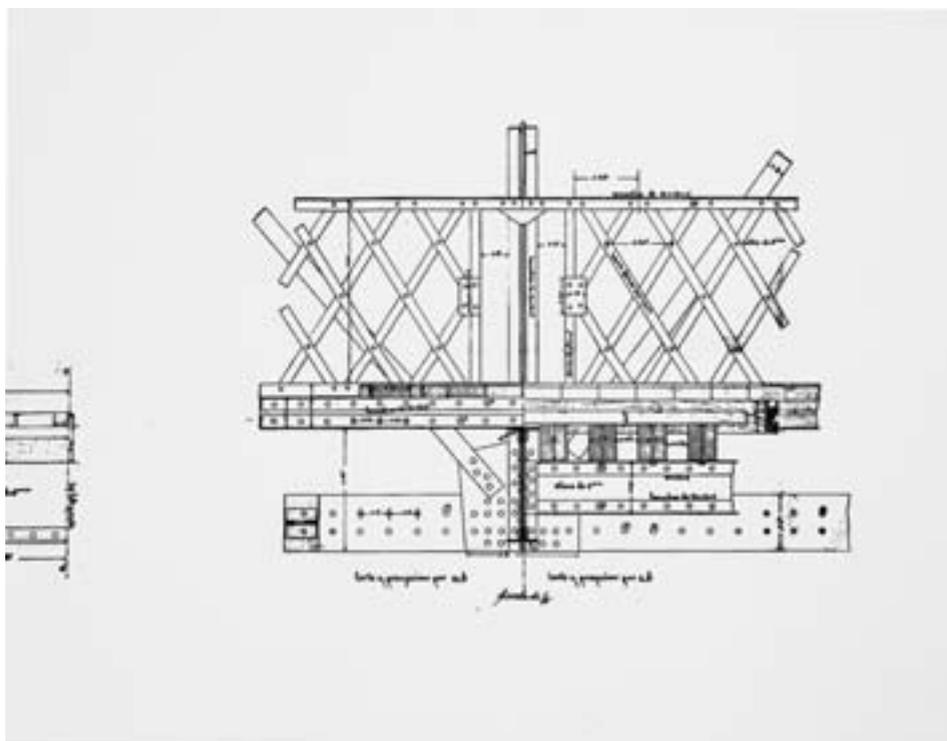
Proyecto del puente de Ontiñena: detalle.
